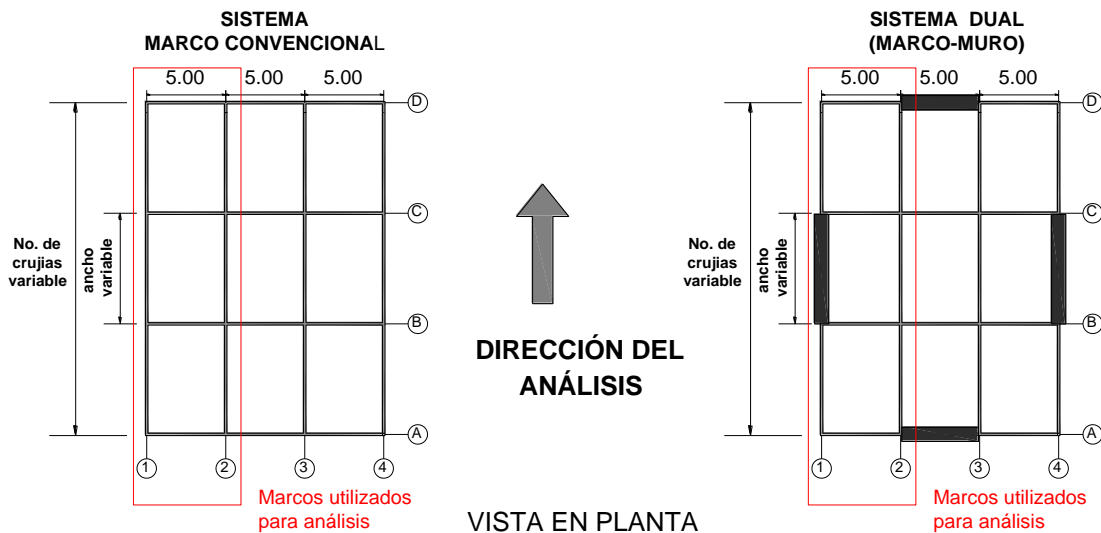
2 Configuración general en planta de los sistemas estructurales estudiados
